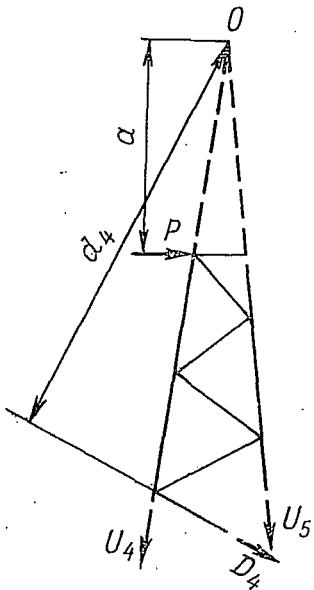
Расчетная схема для определения усилий в ферме с треугольной решеткой
